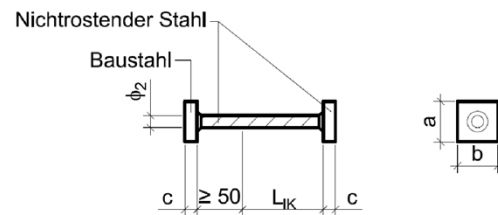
Druckelement aus Stahl mit angeschweißten Druckplatten, einseitig bündig, einseitig min. 50 mm einbindend (bspw. für Schöck Isokorb® Typ K-ID, Schöck Isokorb® RT Typ K)
